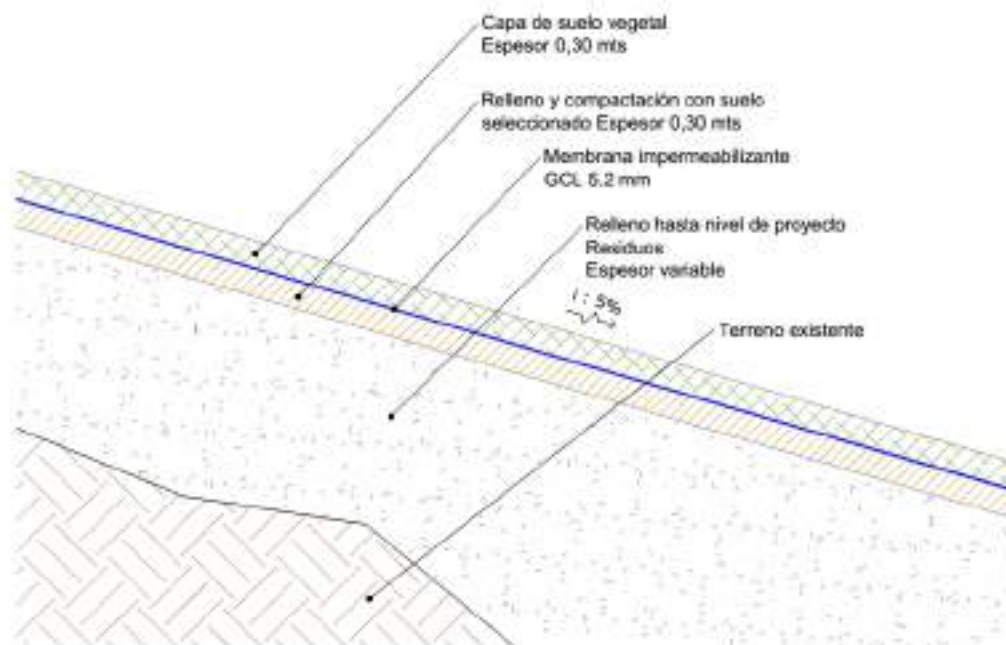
Paquete de Cierre de Módulo – Detalles Detalle paquete impermeable.
